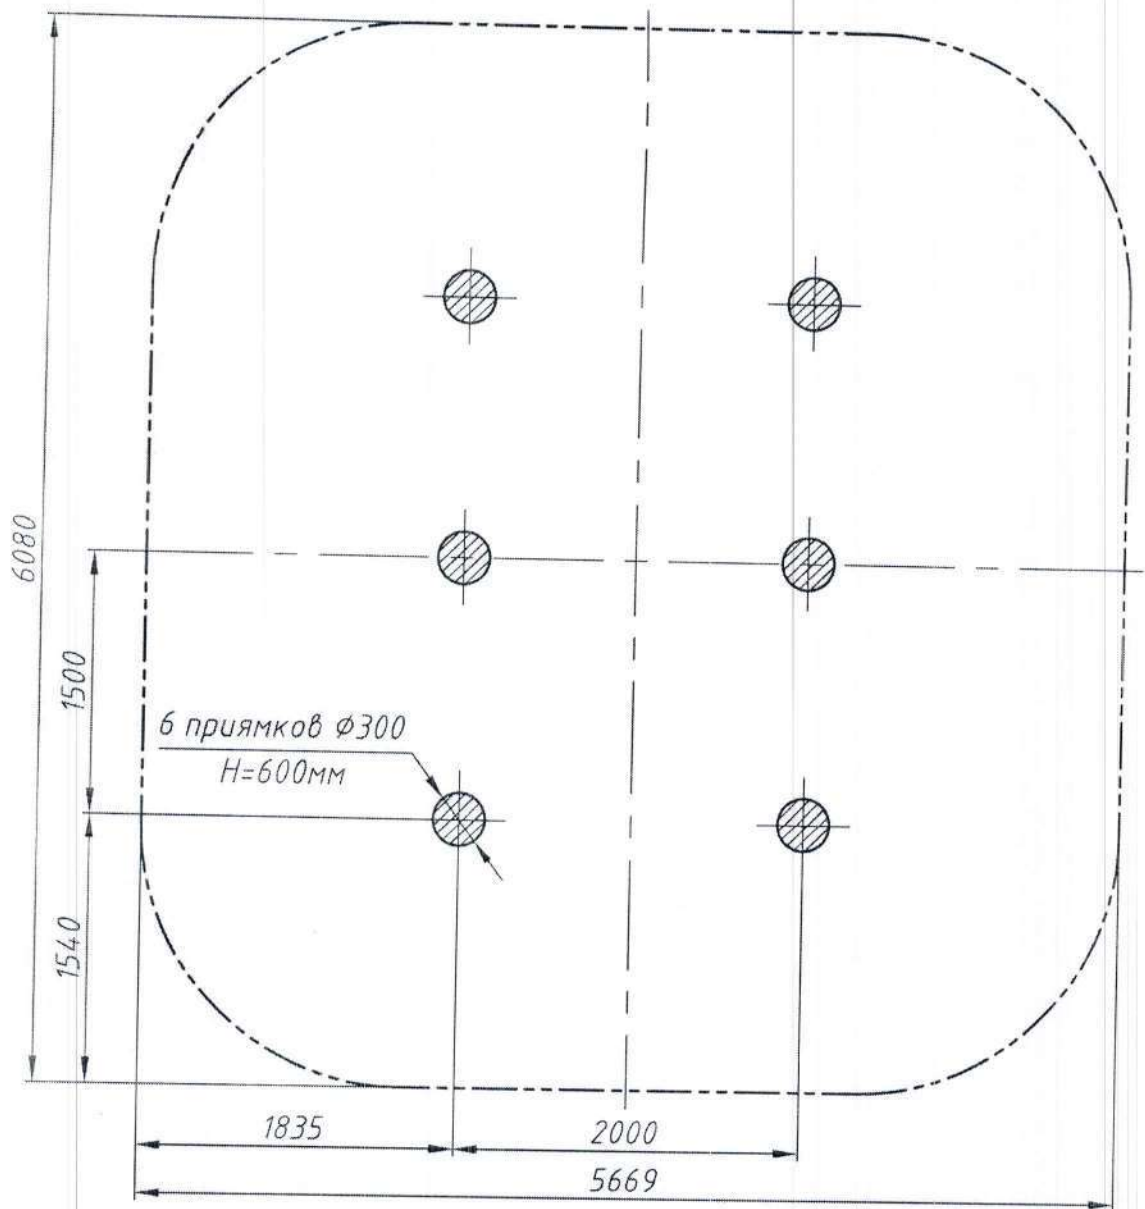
План фундамента Рукохода с кольцами РТР 729D
